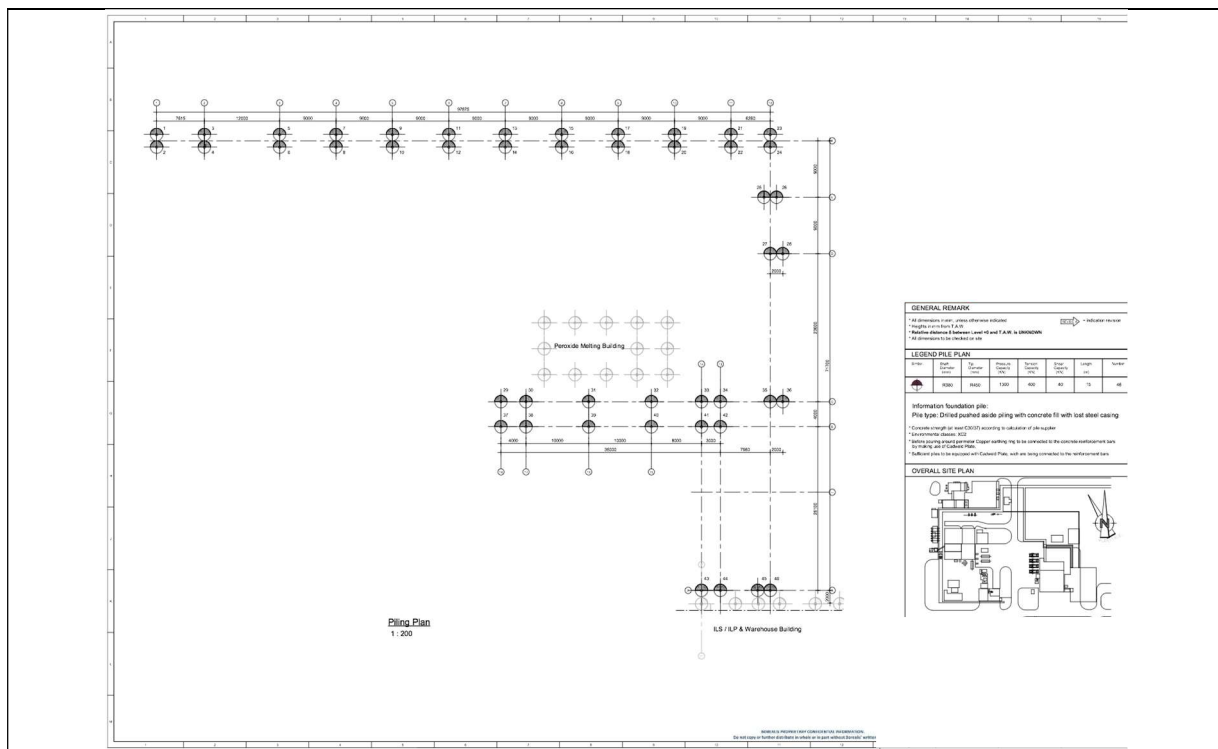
Inplantingsplan geplande werken met aanduiding van de verschillende nieuwbouw.
